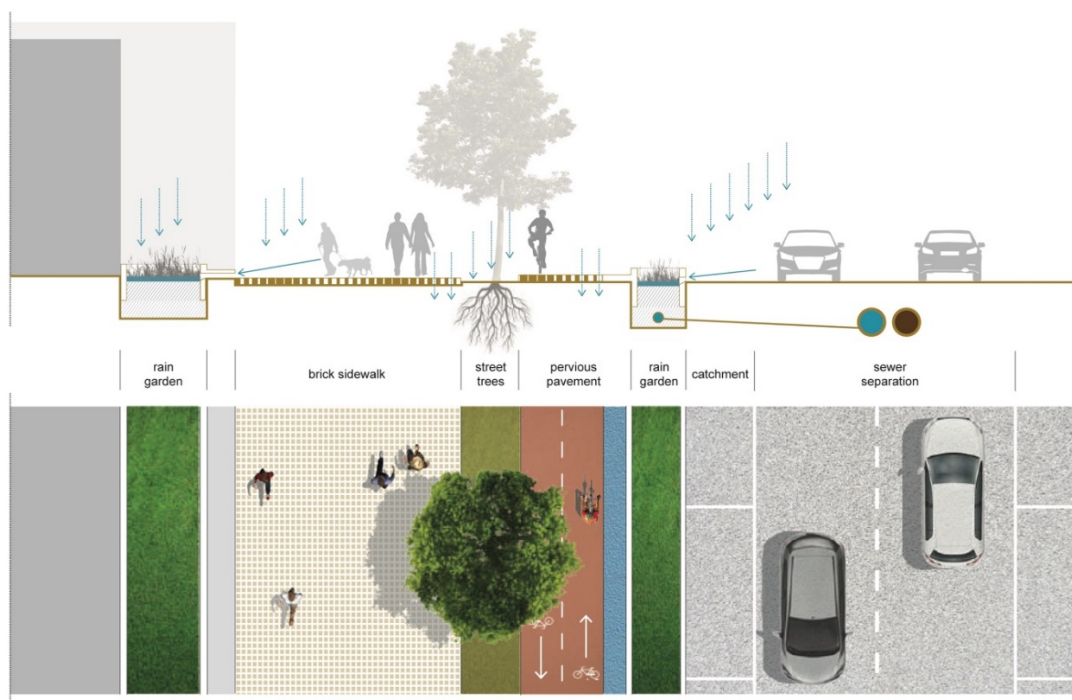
| Greater Boston (Cambridge), sezione e planimetria della Western Avenue.
